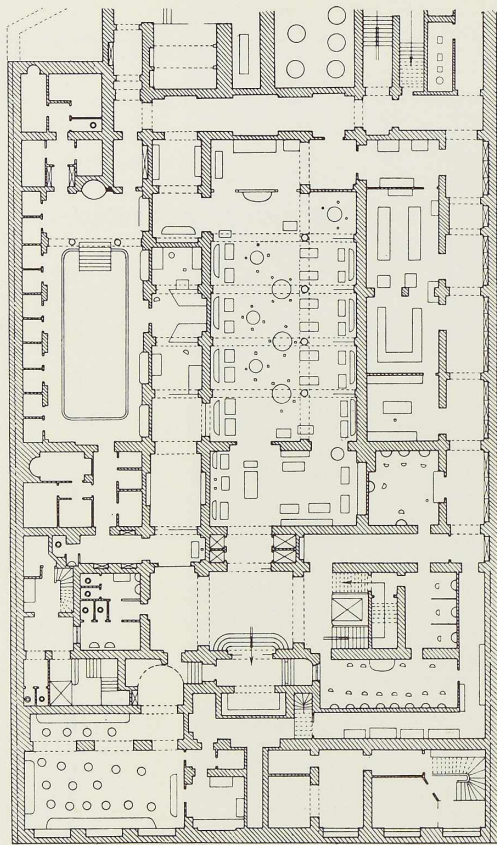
et 24. Vues en plan du sous-sol et du rez-de-chaussée avant transformations.
